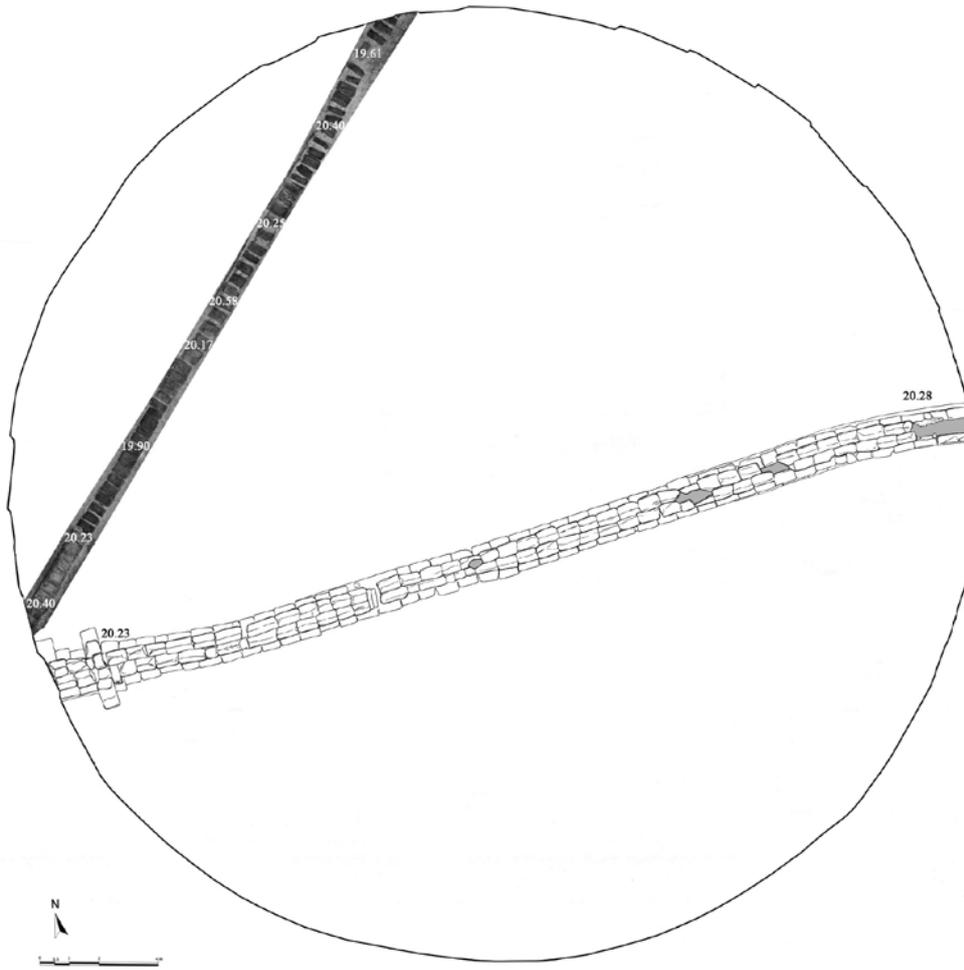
Planimetria generale con ubicazione della struttura lignea (quote riferite al piano di fondo) e dell'acquedotto (quote riferite alla sommità) all'interno del Pozzo 3.2.
